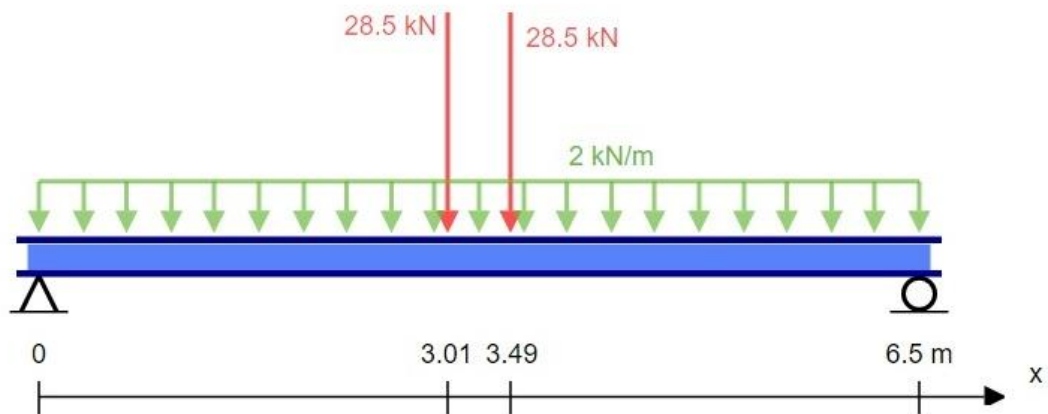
Diagrama de fuerzas aplicadas sobre la viga.
